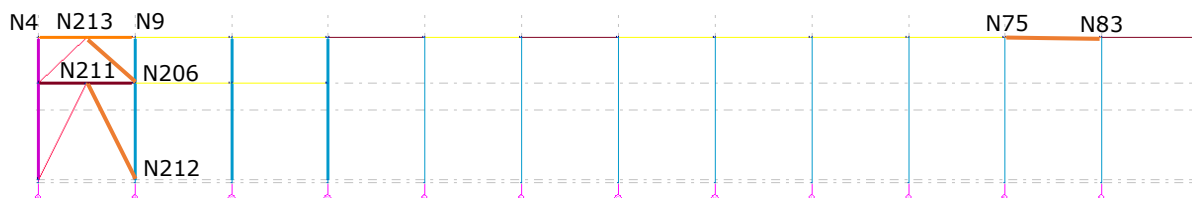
A. Selección de barras de la fachada lateral tipo.
